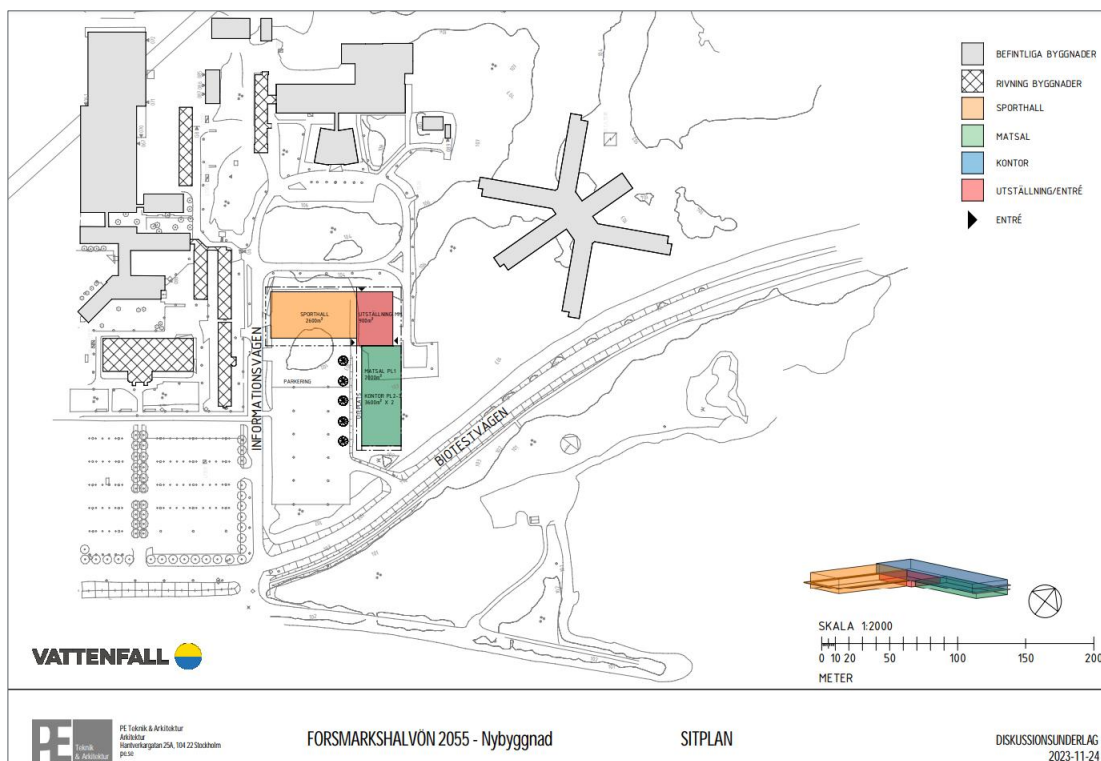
Situationsplan för utveckling av planområdet ovan mark. Källa: Vattenfall.
